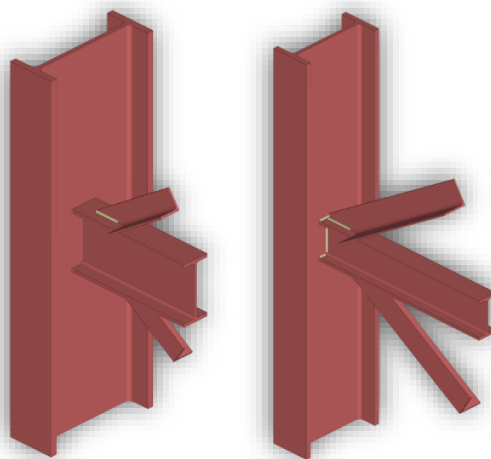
Uniones soldadas entre elementos de apoyos verticales
